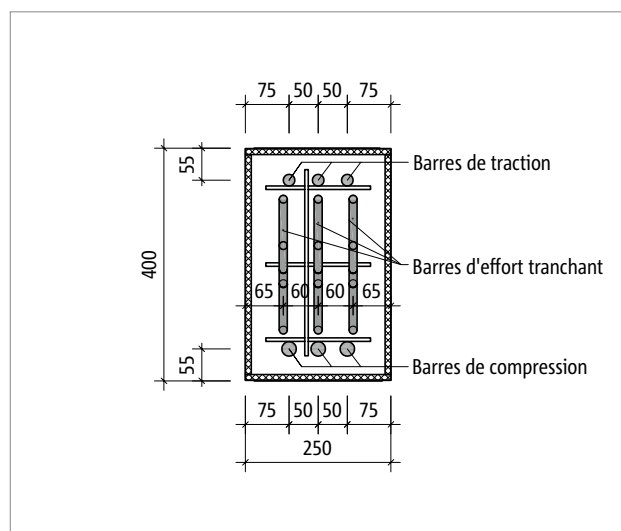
Schöck Isokorb® T Type B-M5-V1 en hauteur H400 : Vue du produit
